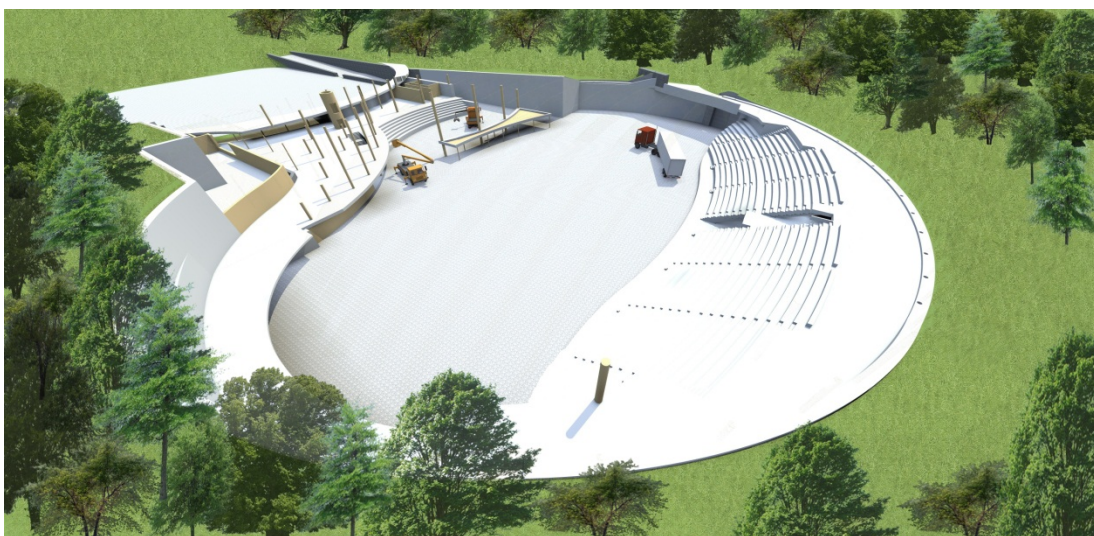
FASE DI CANTIERE – MONTAGGIO STRUTTURE
